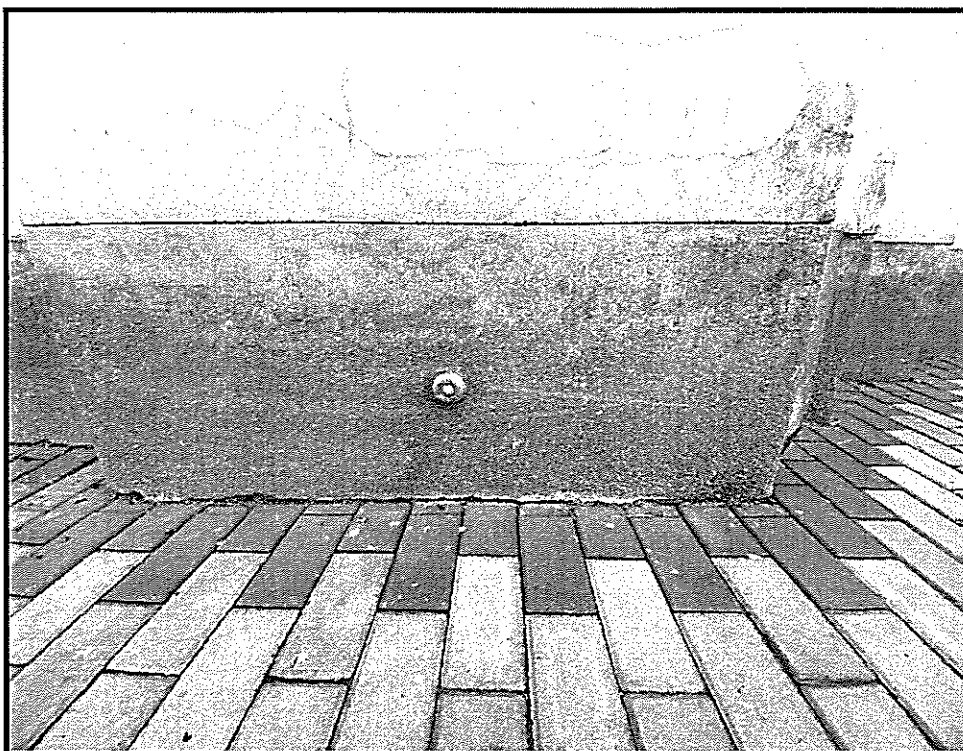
Stan zachowania elewacji frontowej (zachodniej) kościoła w Regnowie.
